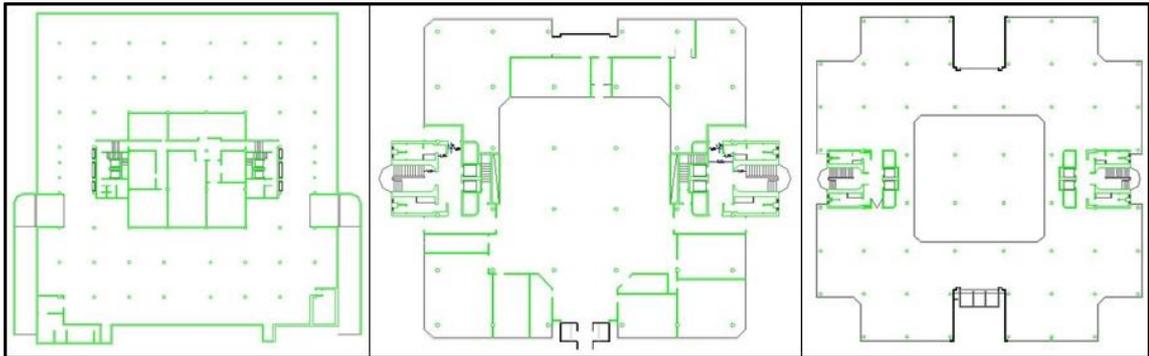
Vista en planta de planta sótano (izquierda), planta baja (centro) y planta primera (derecha).
